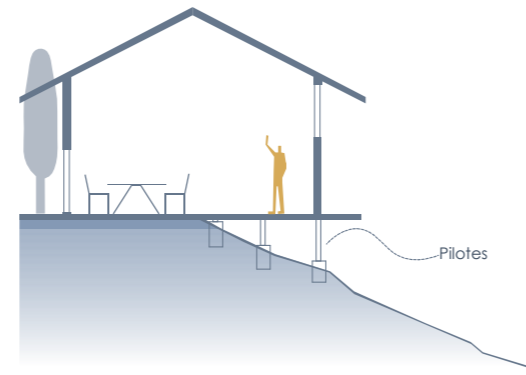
Esquema construcción sobre pilotes en terreno inclinado.
